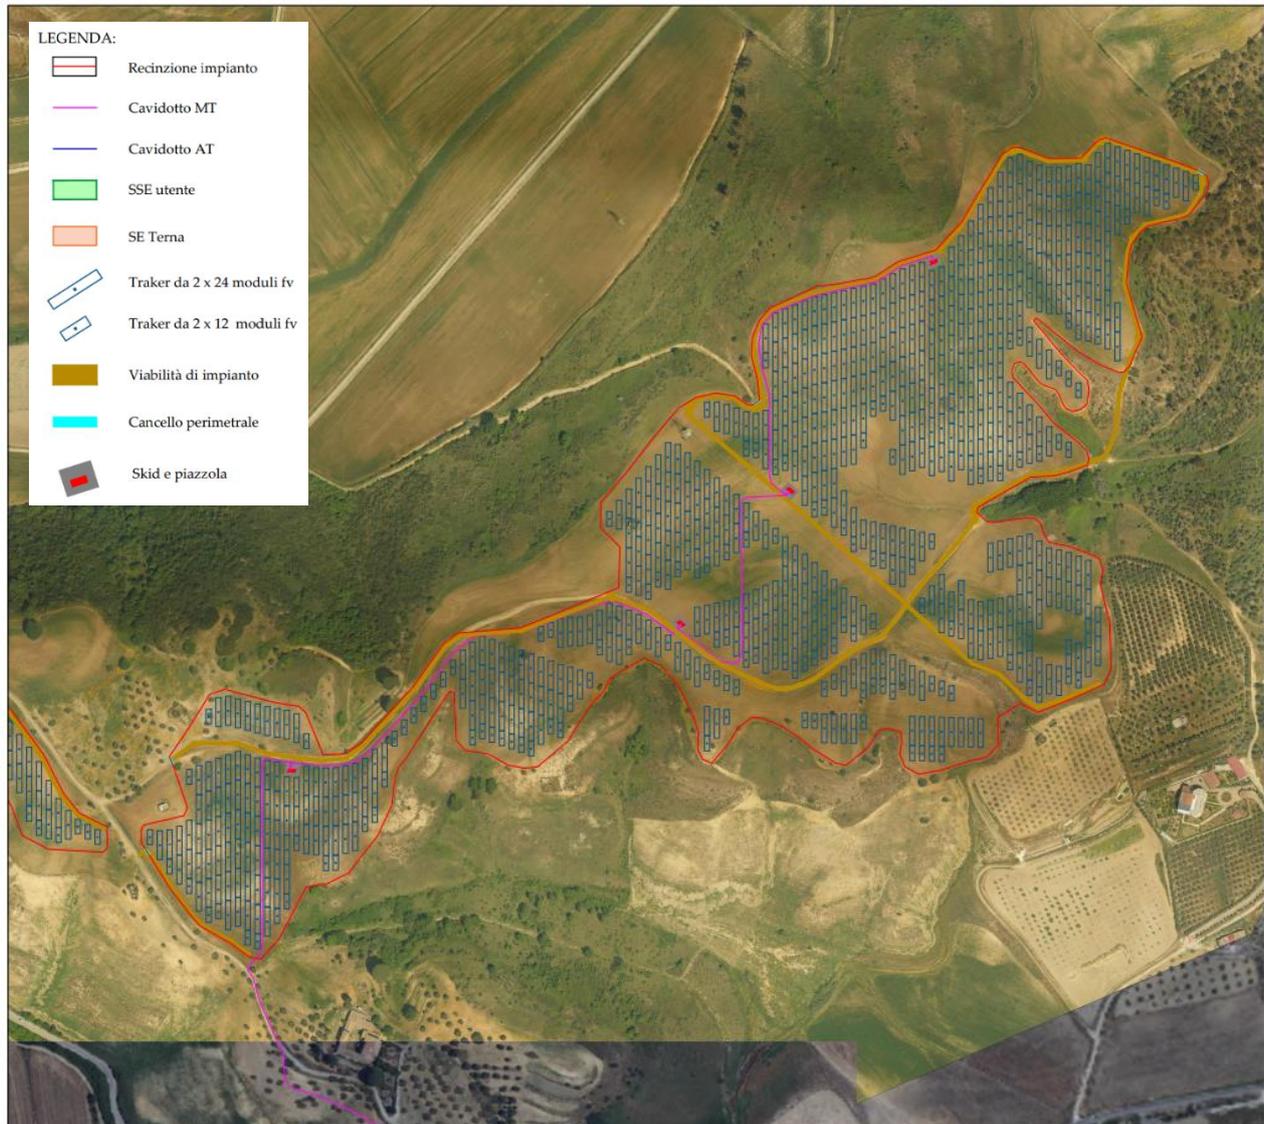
CNLPD0T04-00 - Planimetria Ortofoto
